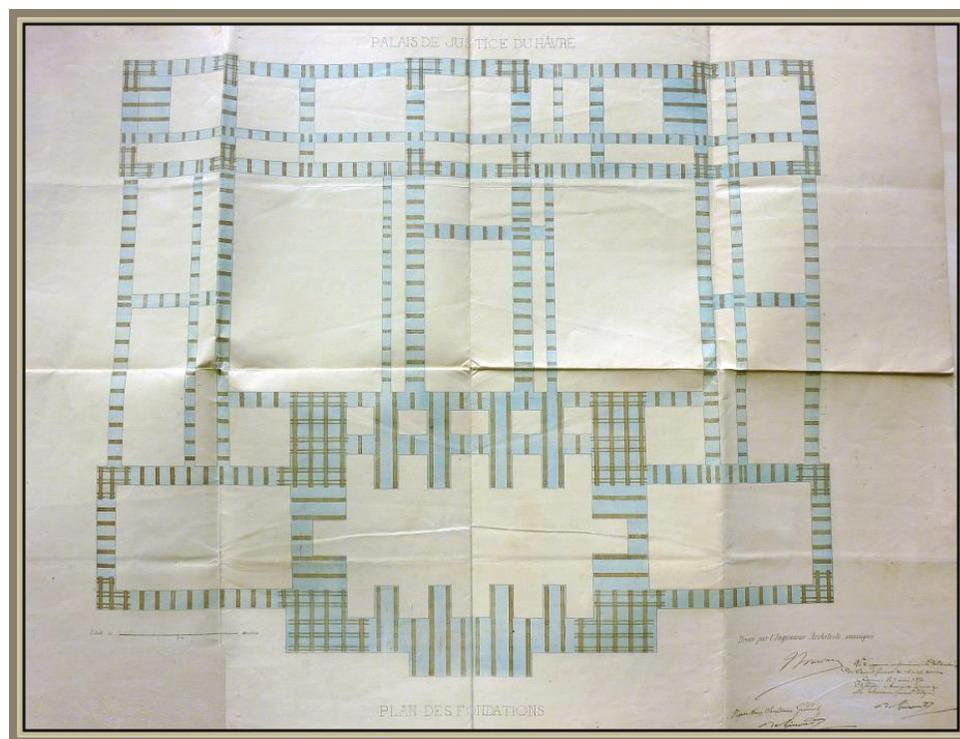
J. Bourdais, système des fondations sur pilotis, plan approuvé le 7 mai 1874
